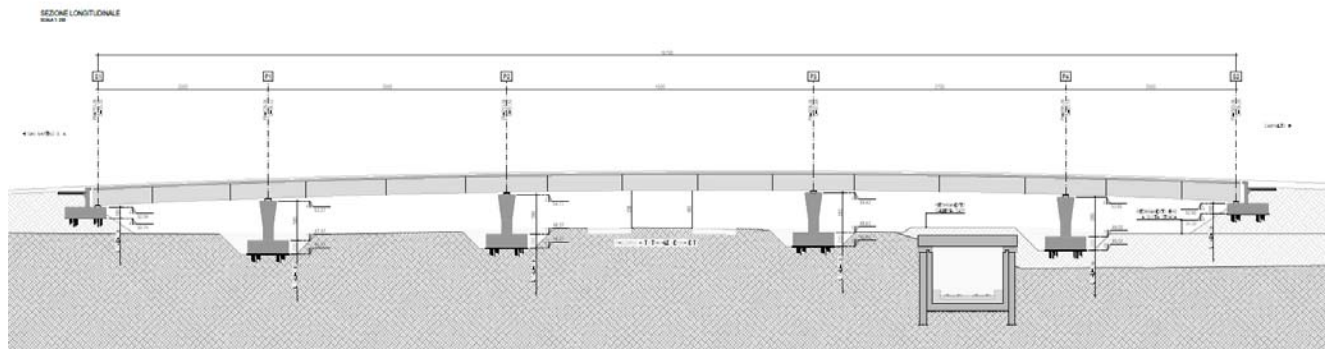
viste e sezioni principali – prospetto longitudinale
